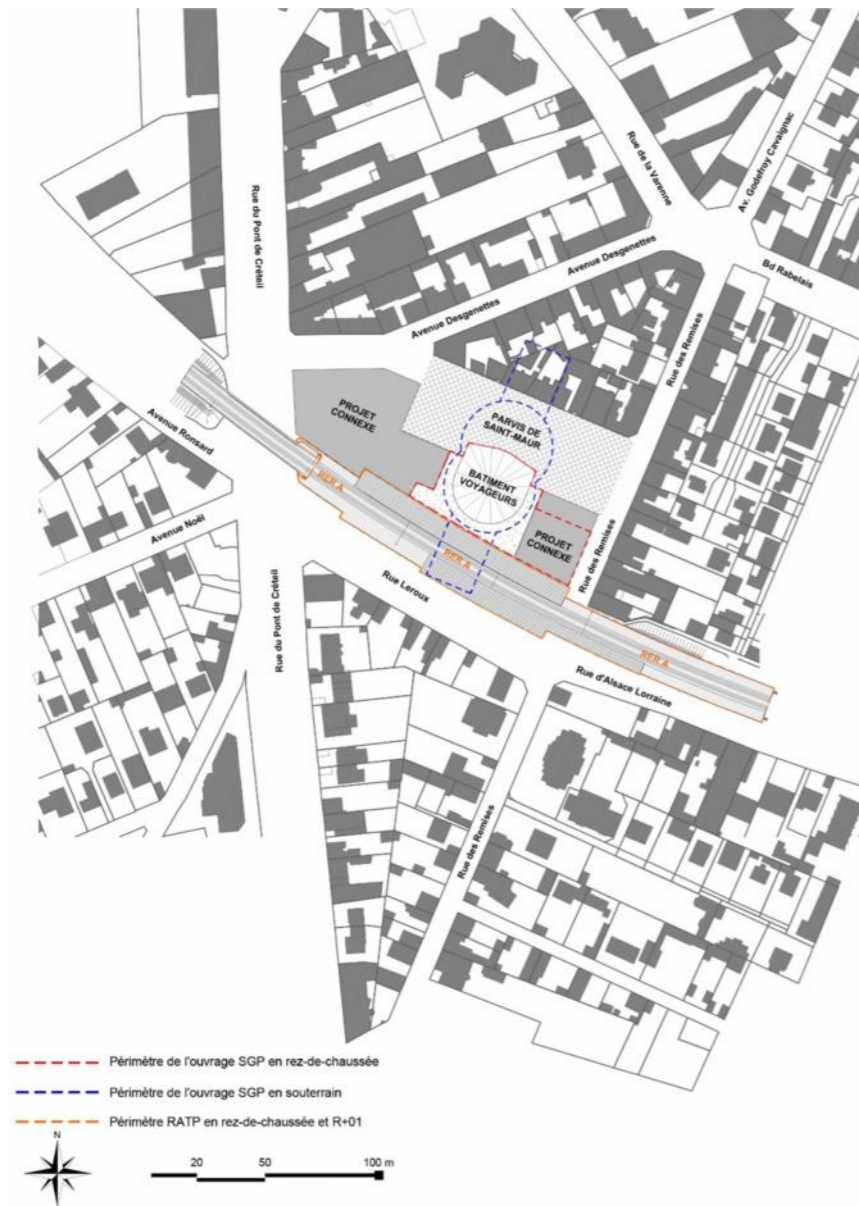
Plan de situation locale, Gare de Saint Maur Créteil
